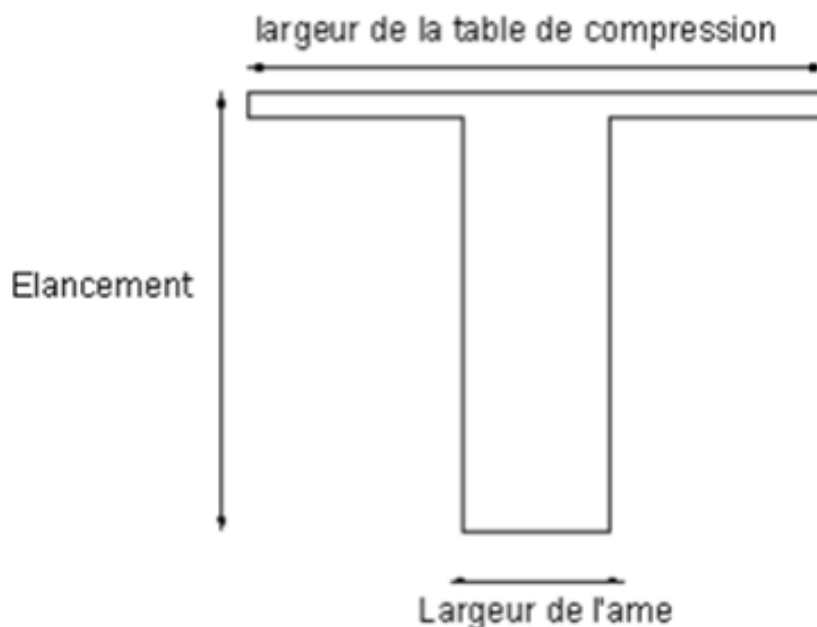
Coupe transversale d'une poutre préfabriquée.
